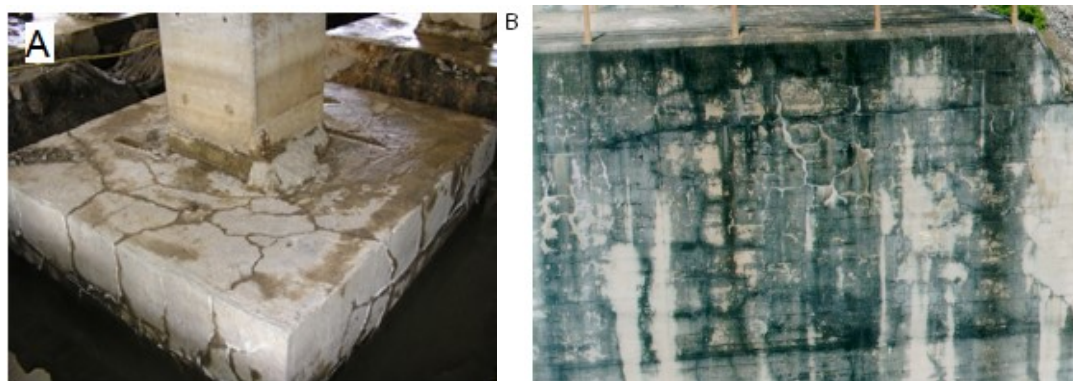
A) Bloco de fundação com fissuração mapeada típica da RAA. Fonte: Pecchioel et al. (2006); B) Barragem de Furnas- Vista lateral do pilar vertedouro. Fonte: SILVEIRA (2006)
